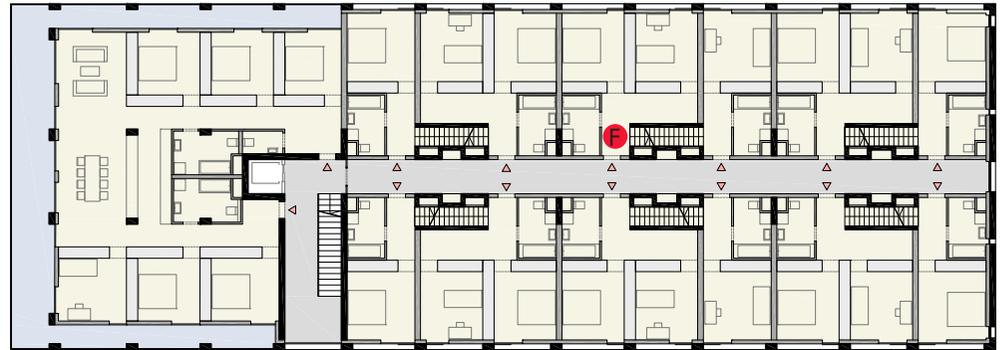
GR 3. Obergeschoß M 1:400 Typ F: Grundrissvariabilität, siehe auch Abb. 107-108
